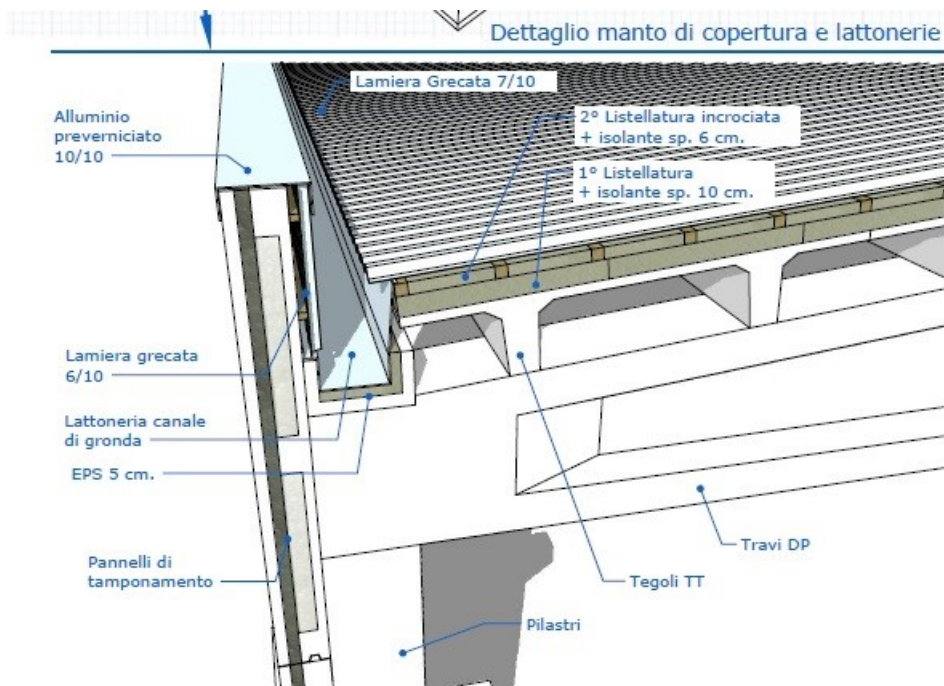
Dettaglio manto di copertura. Fonte impresa "Tre Colli".
